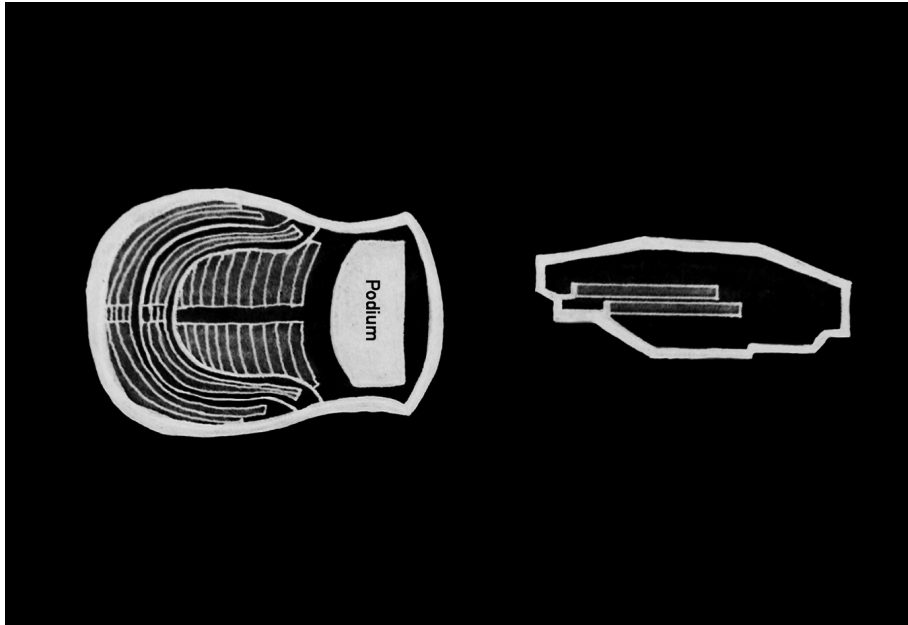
Hufeisen-Saalform (Grundriss, Längsschnitt). Skizzen: Sian Brehler, 2006.
